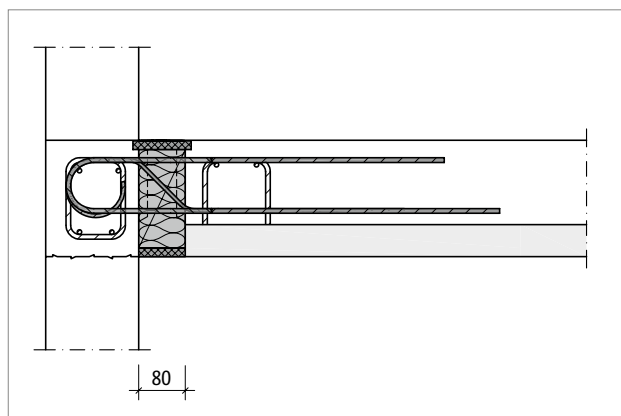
Schöck Rutherma® T type DF : distance minimale par rapport à la façade
